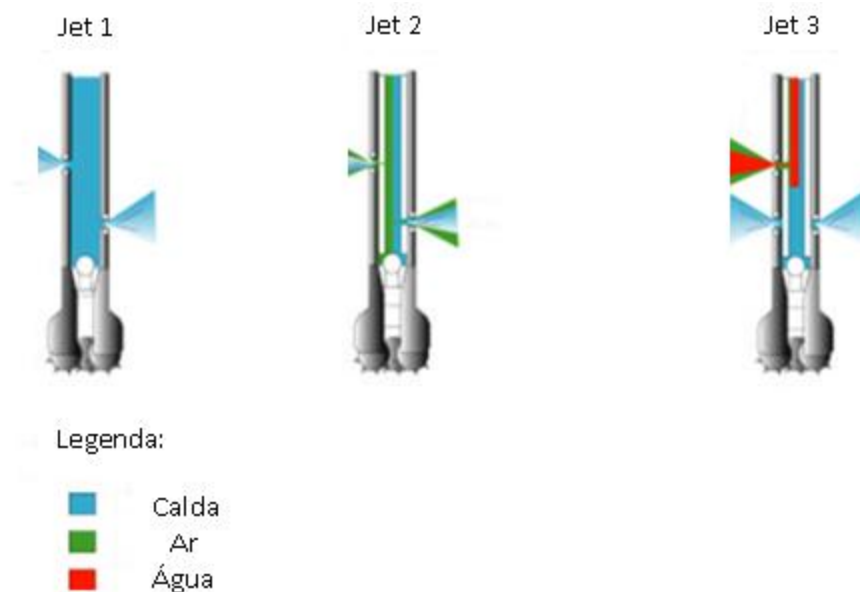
Sistemas de *jet grouting* (adaptado de Layne GeoConstruction, s.d.).
